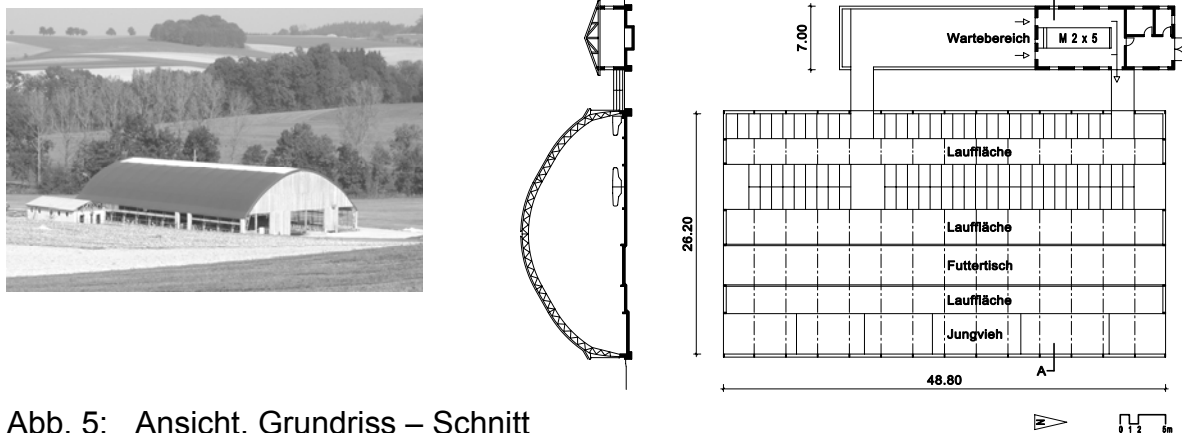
Ansicht, Grundriss – Schnitt
